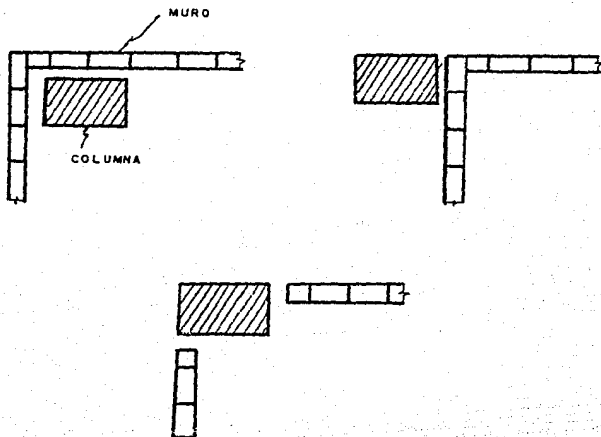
Alternativas para desligar los muros de la estructura en elevación.
